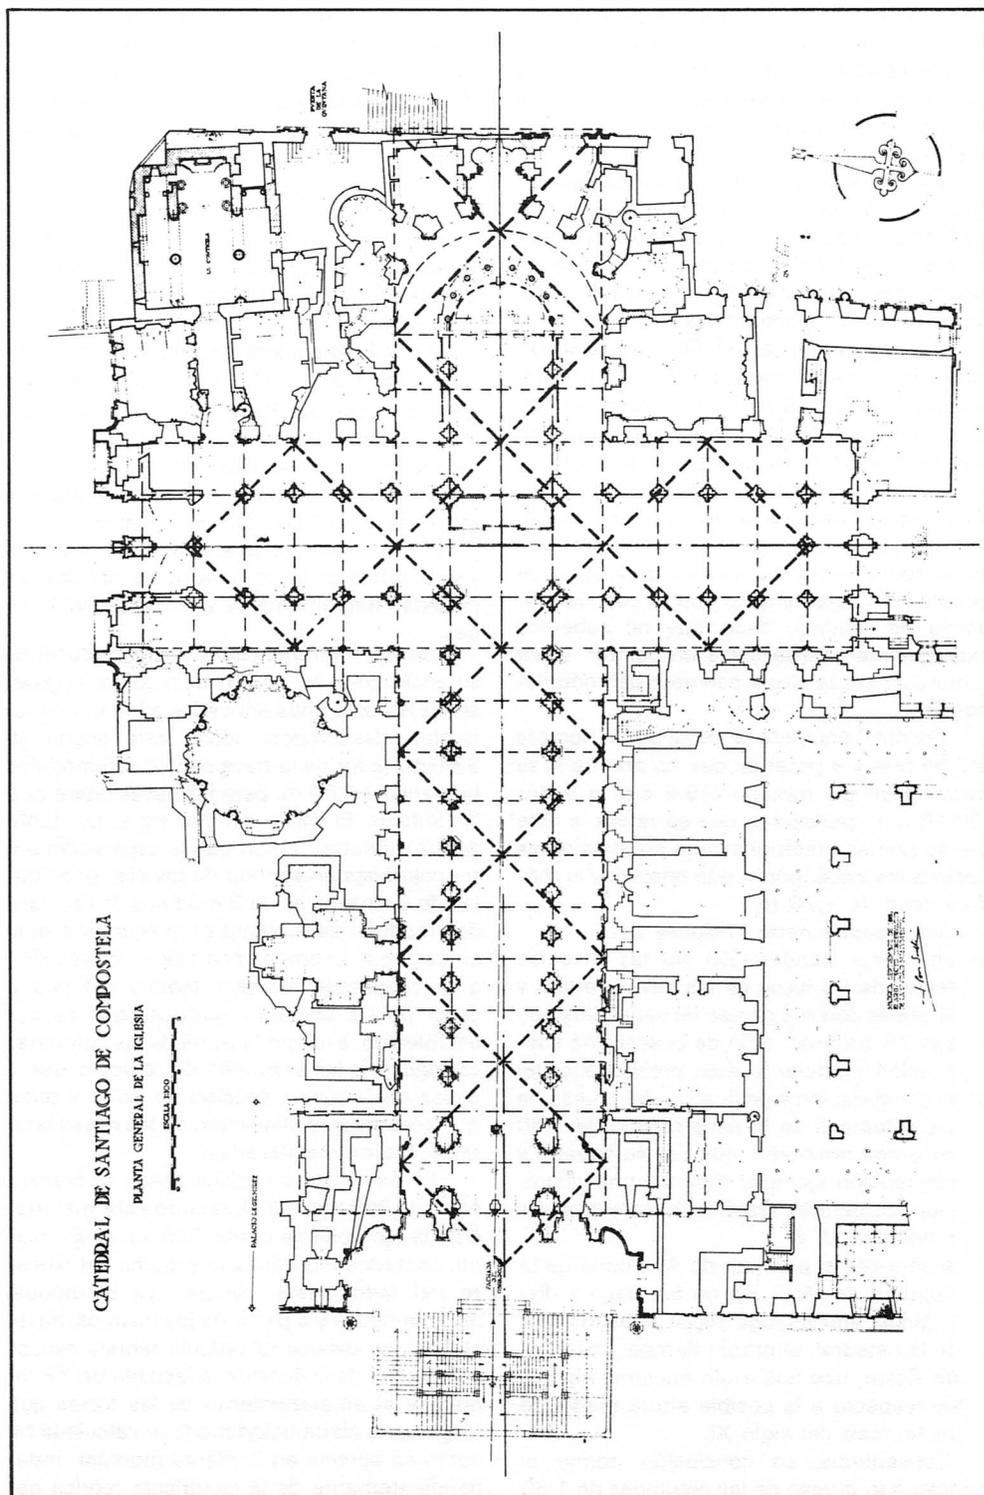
Trazado regulador sobre la planta de la catedral de Santiago
